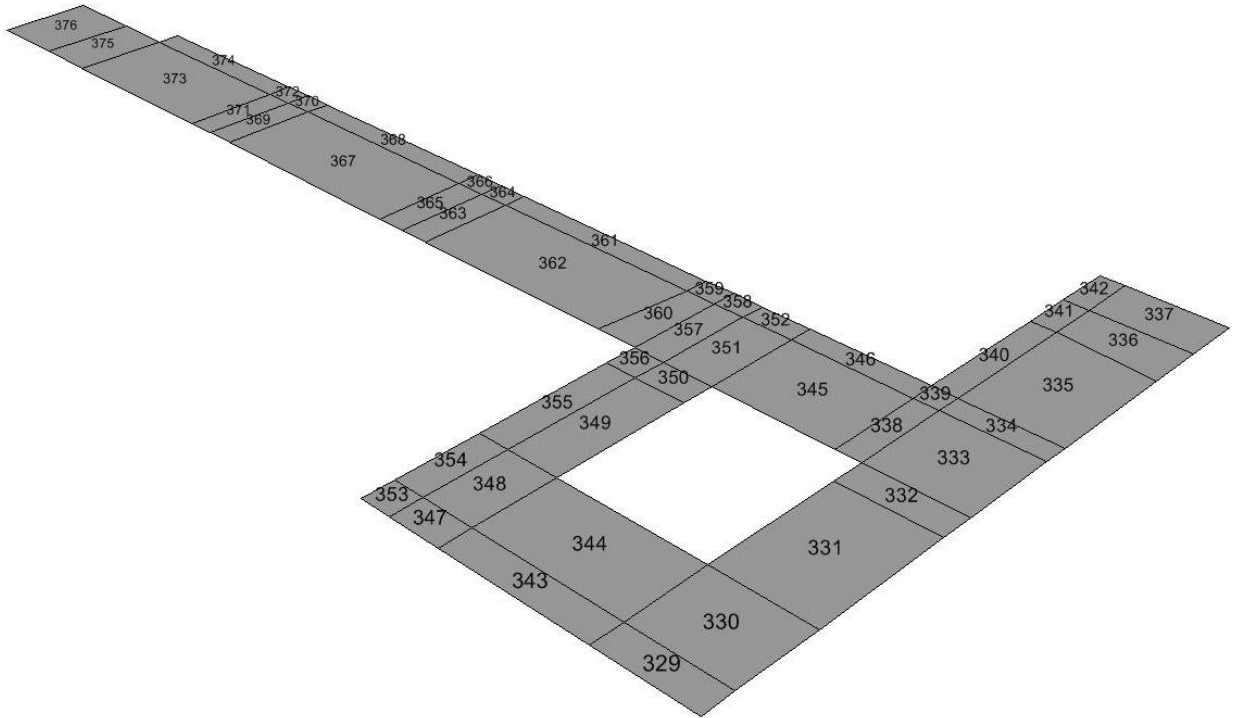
Asignación de carga muerta sobre elementos de losa de cubierta
